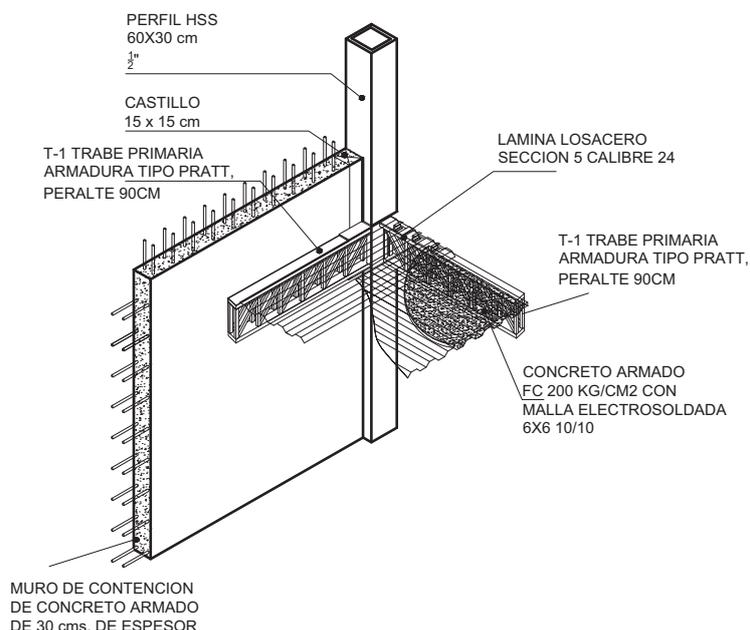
DETALLE SISTEMA CUBIERTA LOSACERO
